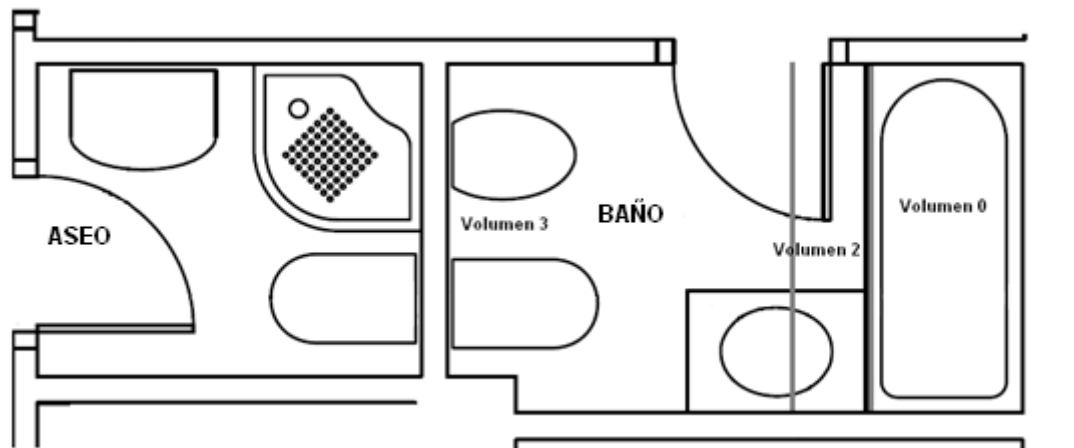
Volúmenes de seguridad en el baño de las viviendas
